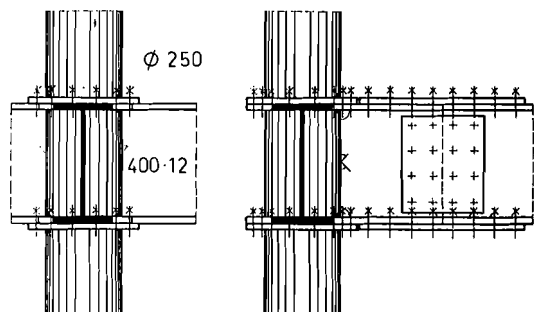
Rahmenknoten mit Rohrstütze und geschraubtem Baustellenanschluß
